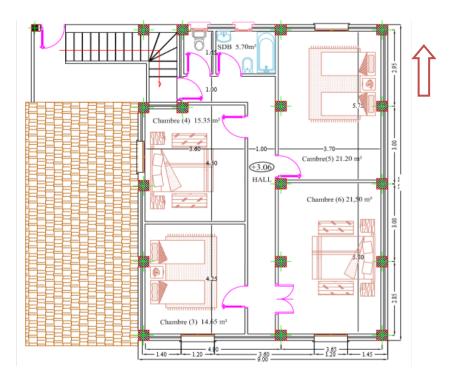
Vue en plan du $1^{\rm er}$ étage réalisé par autocad
